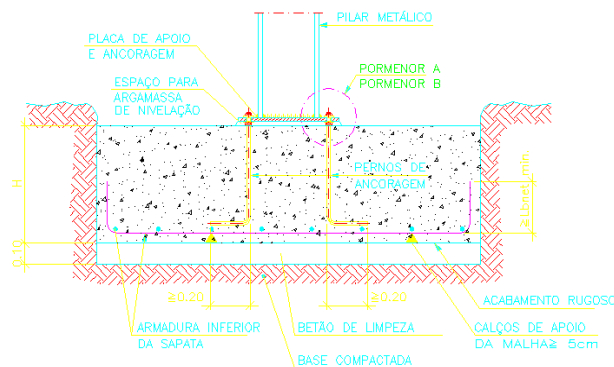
Fundação dos pilares metálicos – pormenor tipo
